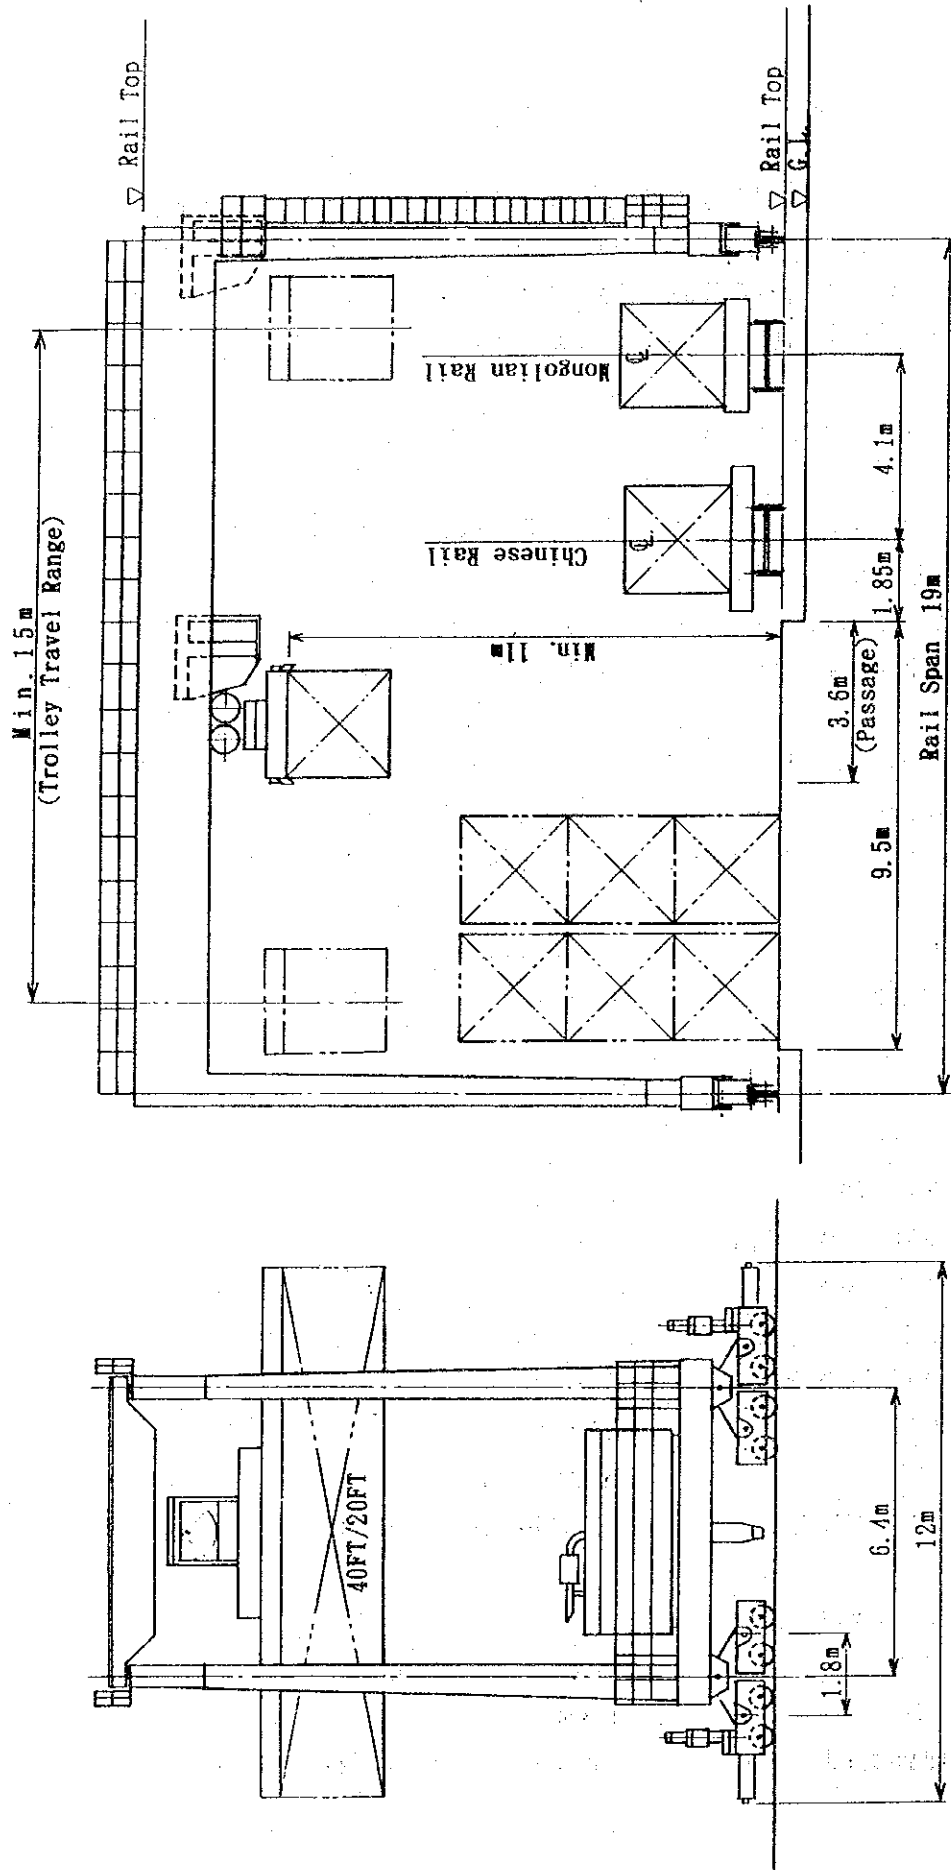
ガントリックレーン (コンテナ用) 全体配置図
